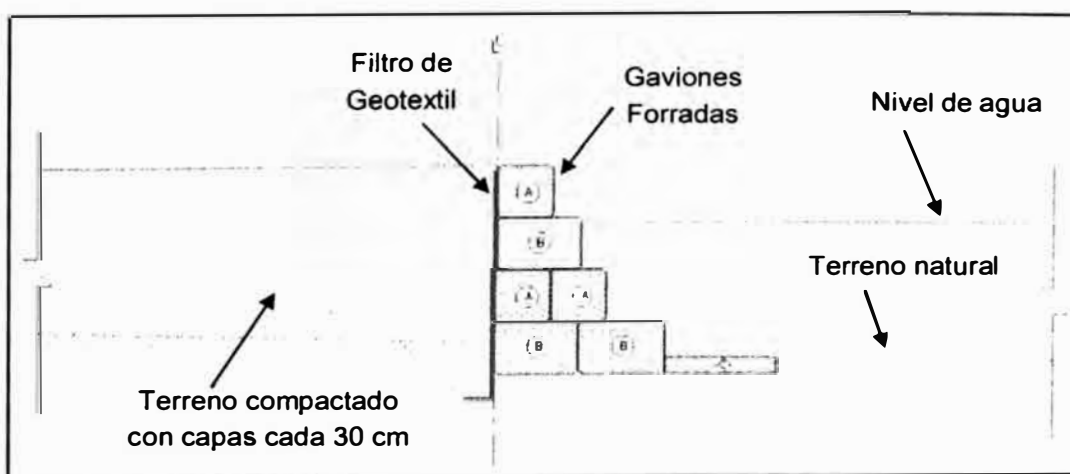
Sección típica de los gaviones y el geotextil de protección.
